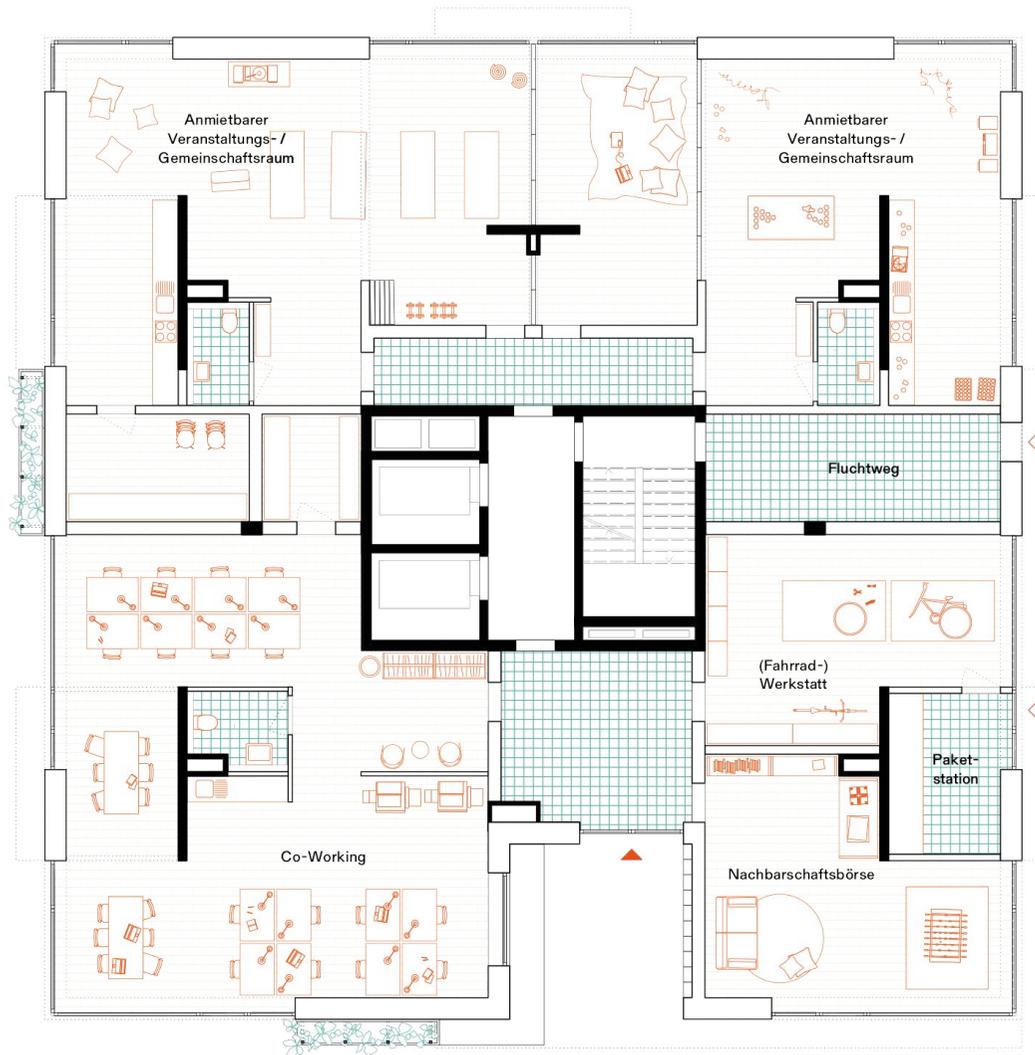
Erdgeschoss | M 1:175 | 03 Arch. GmbH (München)
